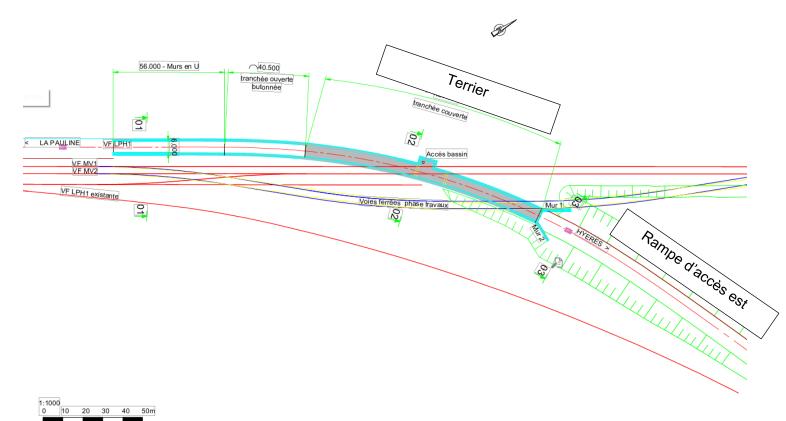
Vue en plan du terrier et des rampes d'accès (source : Egis, 2021)
